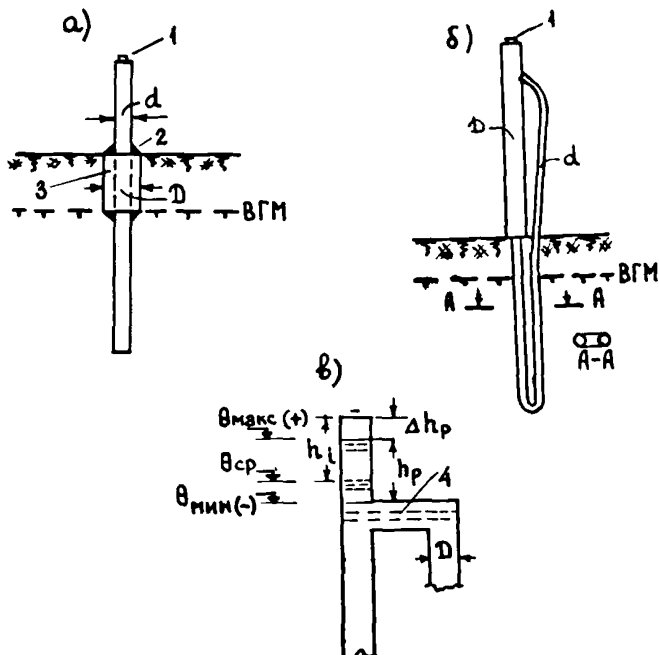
Термоохладители системы С.И.Гапеева: а – однотрубный; б – двухтрубный; 1 – пробка; 2 – сварка; 3 – воздушный зазор 10–20 мм; 4 – керосин
